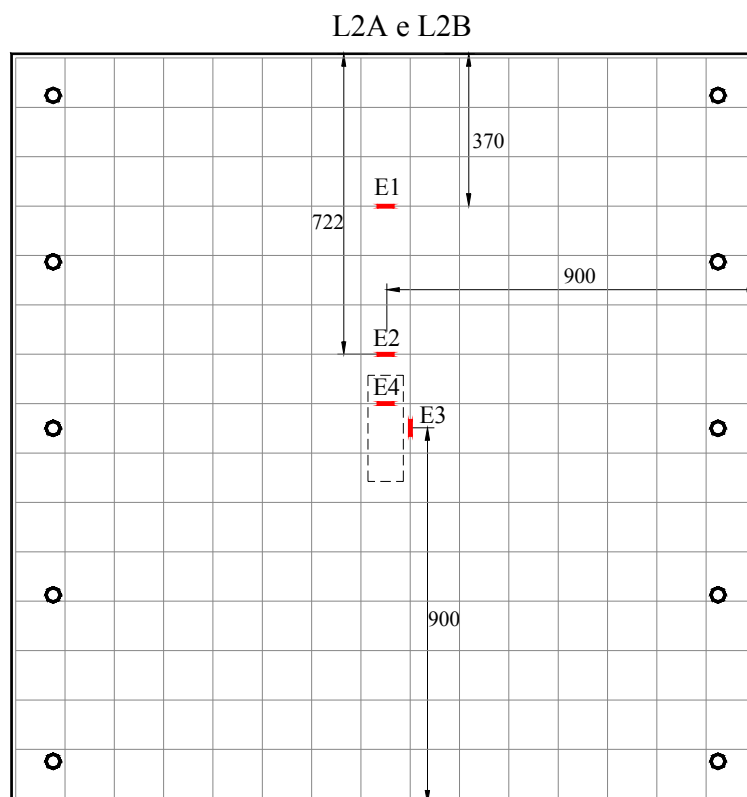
Instalação de extensômetros nas armaduras principal e secundária das lajes L2A e L2B
